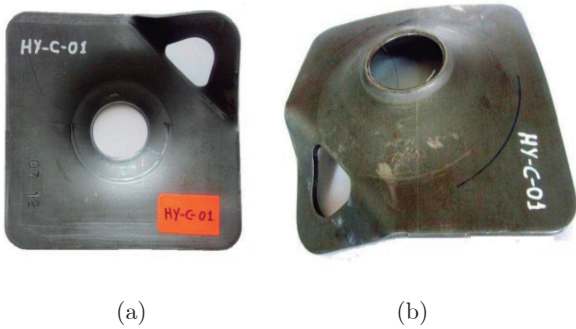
Estado final de las placas después de las pruebas de compresión. (a) Posición de compresión. (b) Posición inversa al ensayo.
